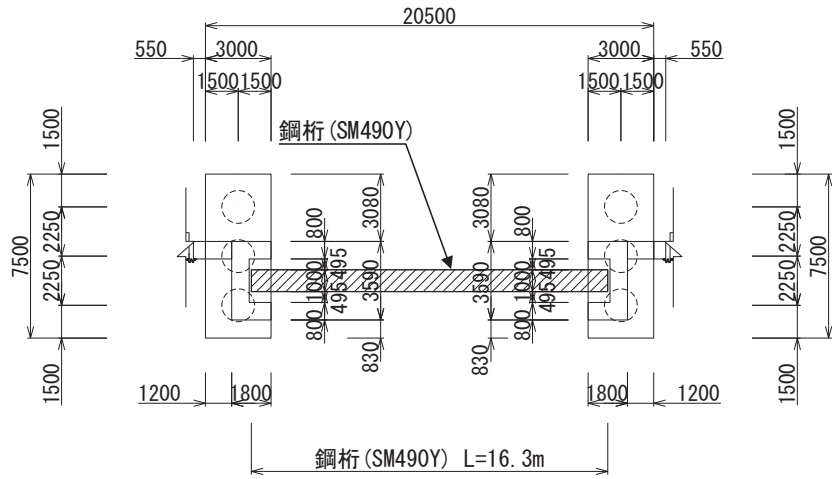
(2) 鋼製遮水壁（鋼桁 6） 平面図
